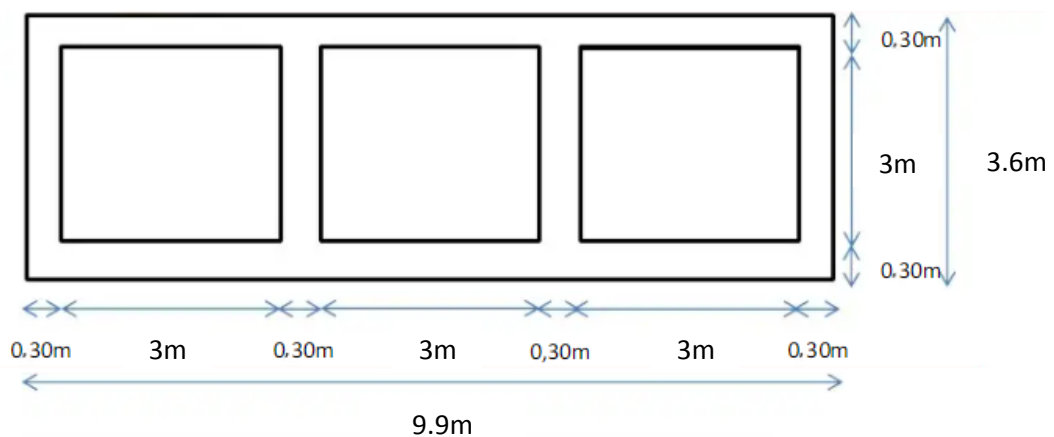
profile en travers du dalot de la route N11 tronçon G2
